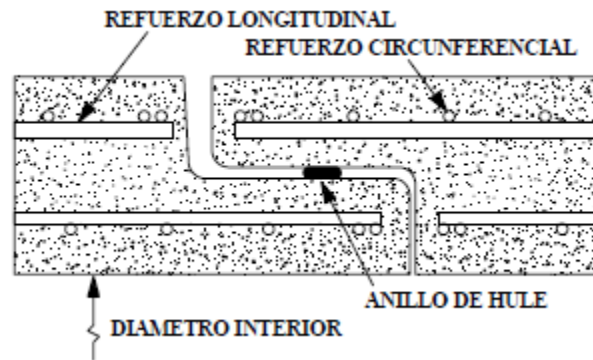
Unión espiga-campana en tuberías de concreto con cilindro de acero
